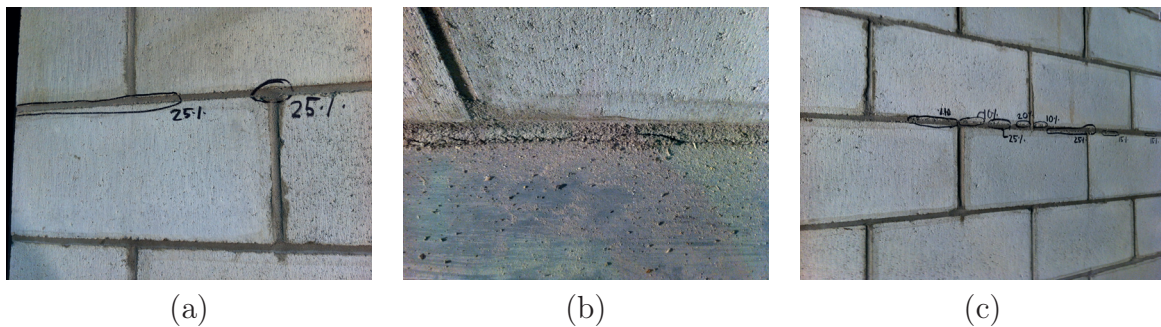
Photos de l'endommagement du mur 1 après l'essai MAL8-0.25 (a) extrémité gauche de la façade avant du mur (b) endommagement à la base du mur sur la façade avant (c) endommagement de la partie centrale sur la façade avant du mur
